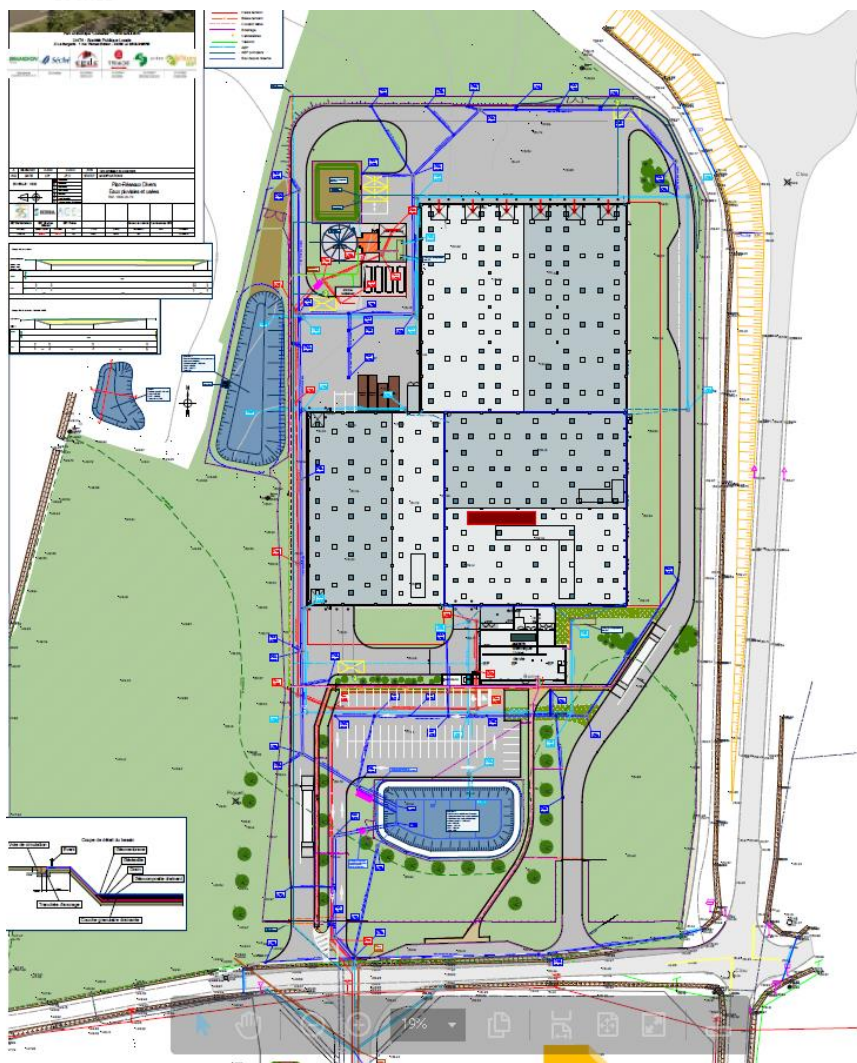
Plan des réseaux (source : groupement Trinovia)
